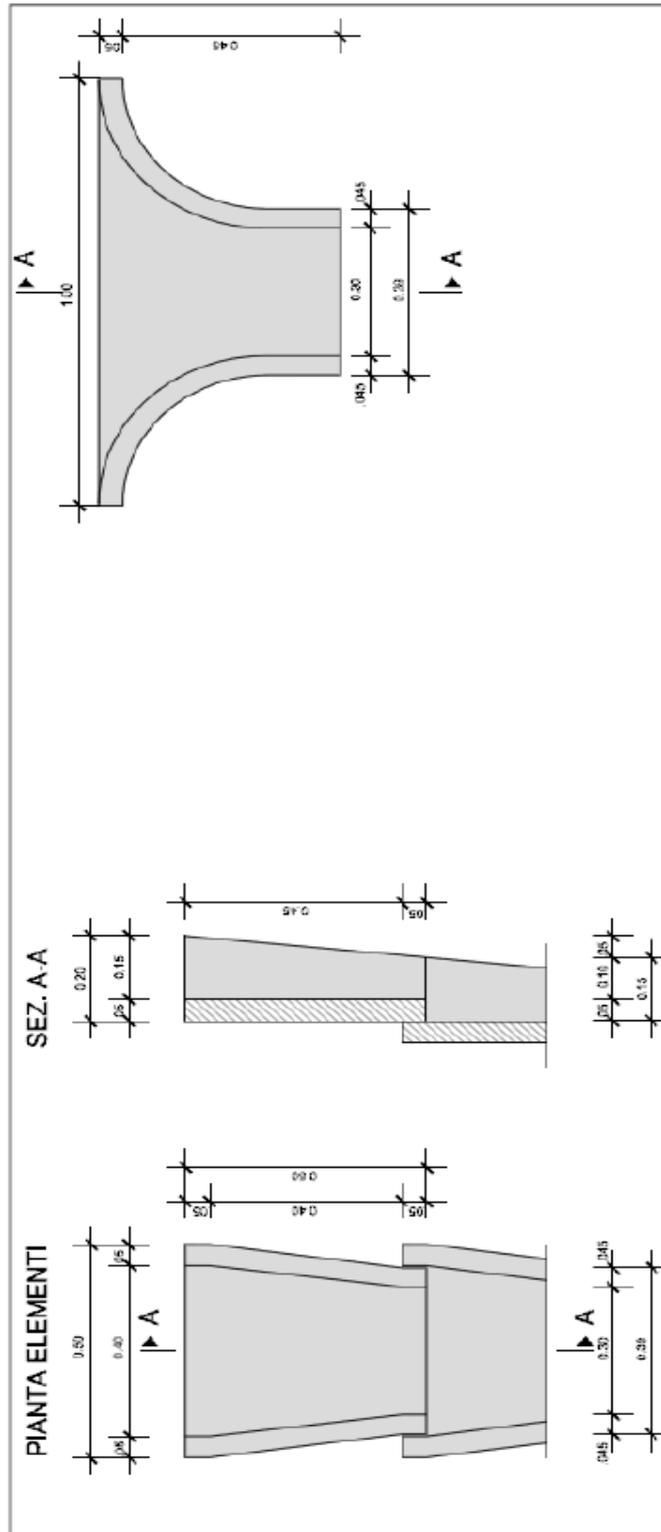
Dettaglio degli embrici in pianta e in sezione
